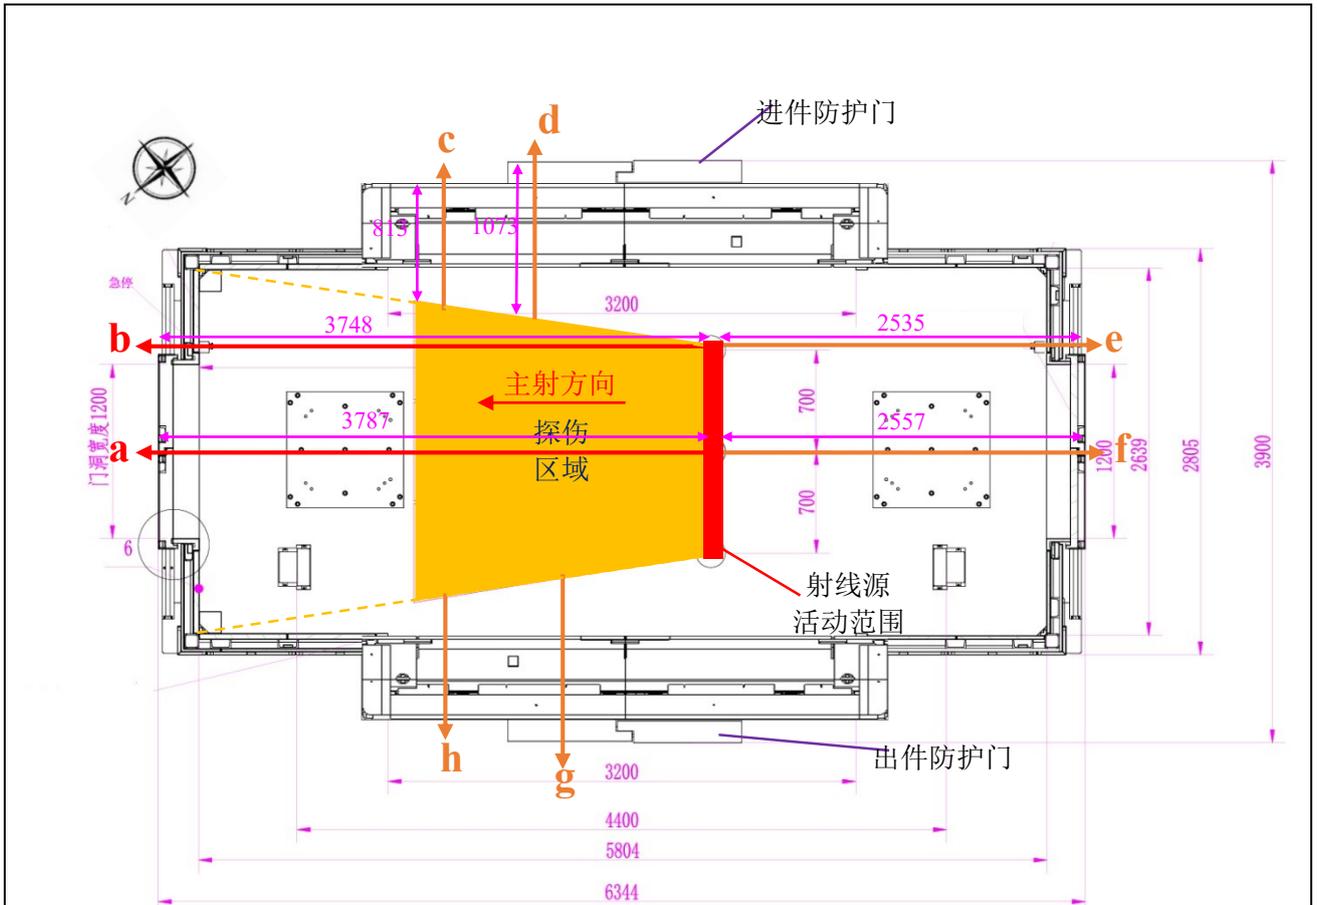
辐射屏蔽计算预测点位图 (单位: mm)
